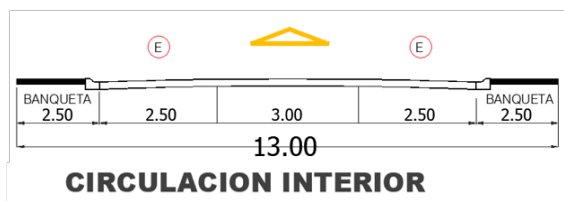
Sección vial propuesta dentro del fraccionamiento.
